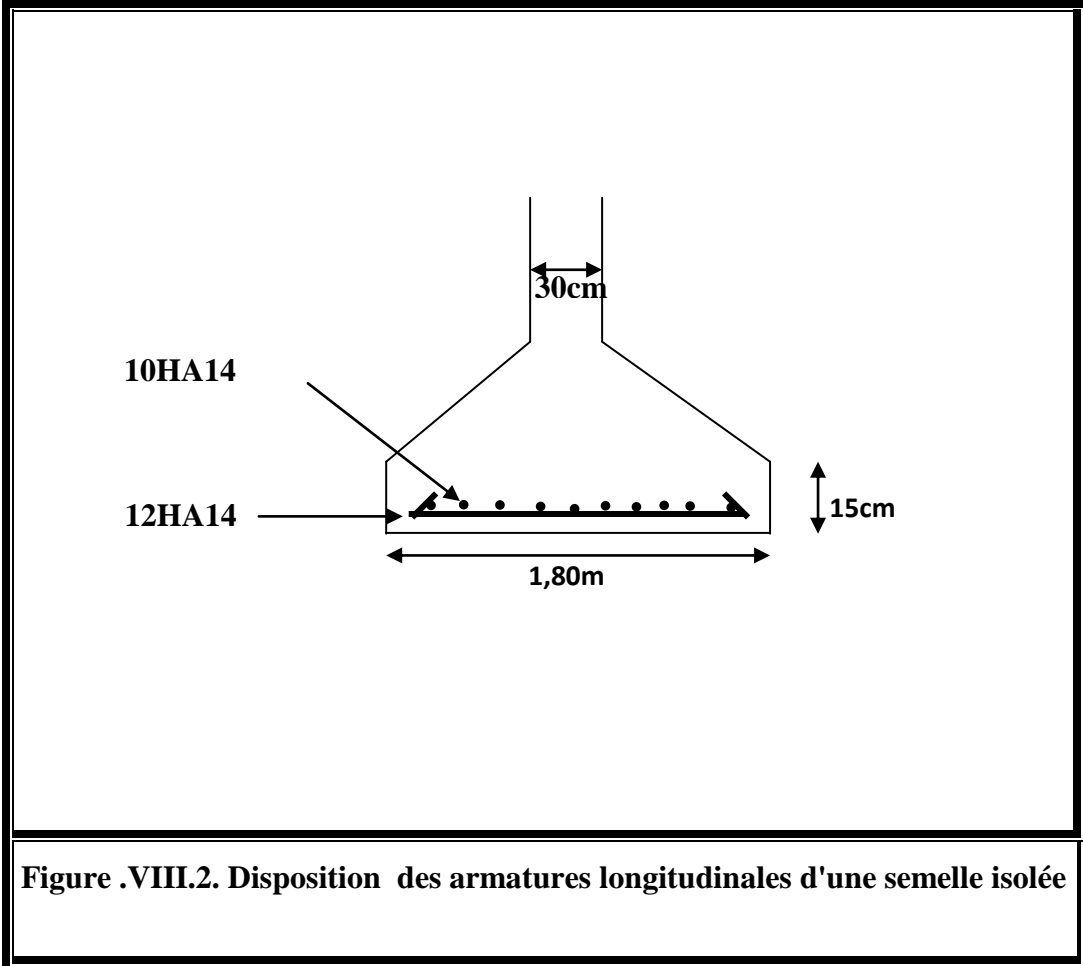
Disposition des armatures longitudinales d'une semelle isolée
